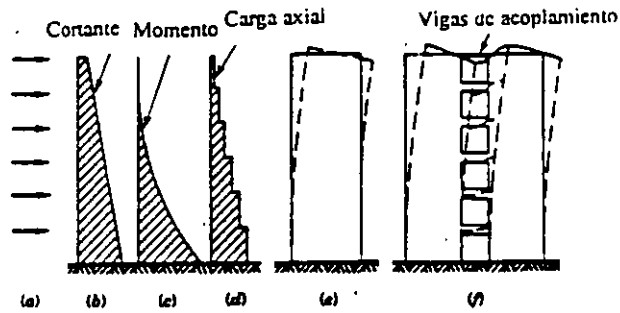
Variación de la fuerza cortante, momento y carga axial en un muro estructural aislado
